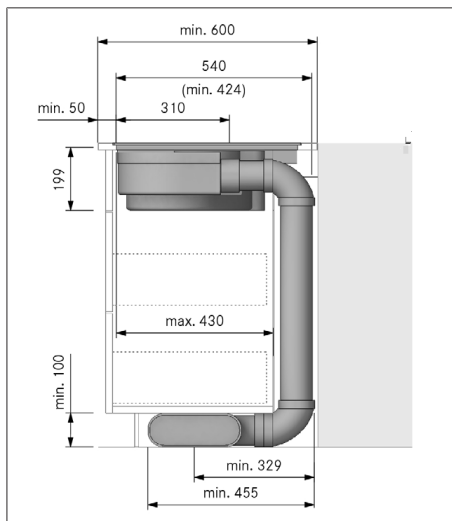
Monteringsdimensjoner ved uttrekking, benkeplatedybde 600 mm
